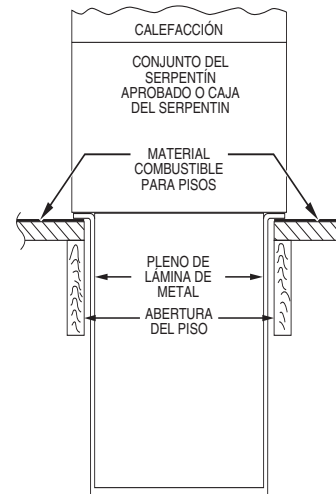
Calefactor, cámara y conjunto del serpentín o caja del serpentín instalados en un piso combustible
